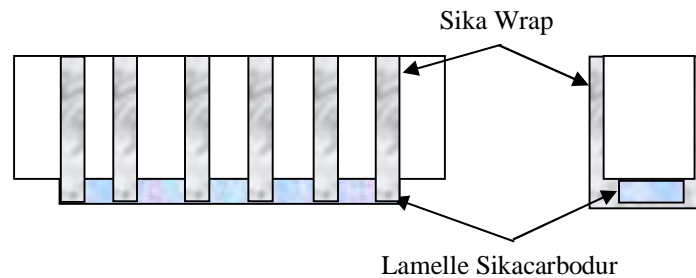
Renforcement en bandes aux faces latérales et lamelle en face inférieure
